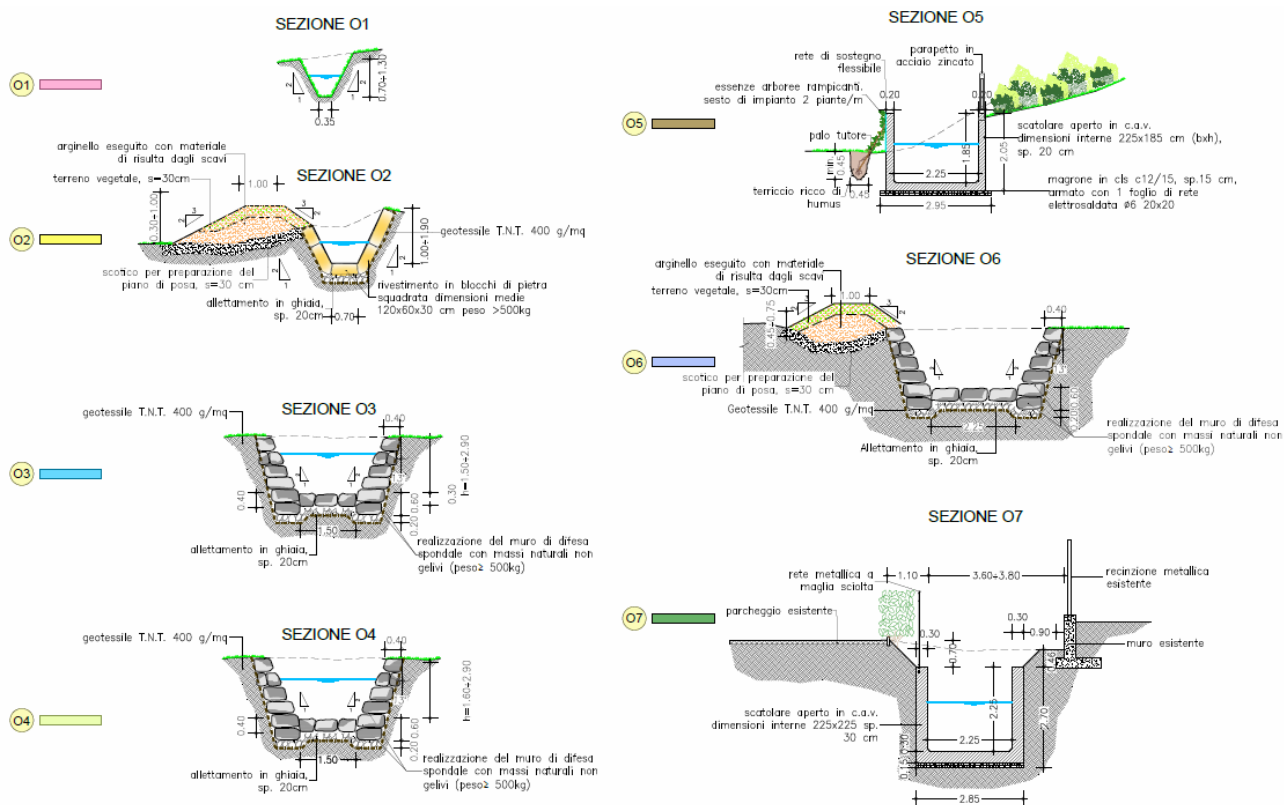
sezioni tipo fosso Ovest. Estratto elaborato T-04.
